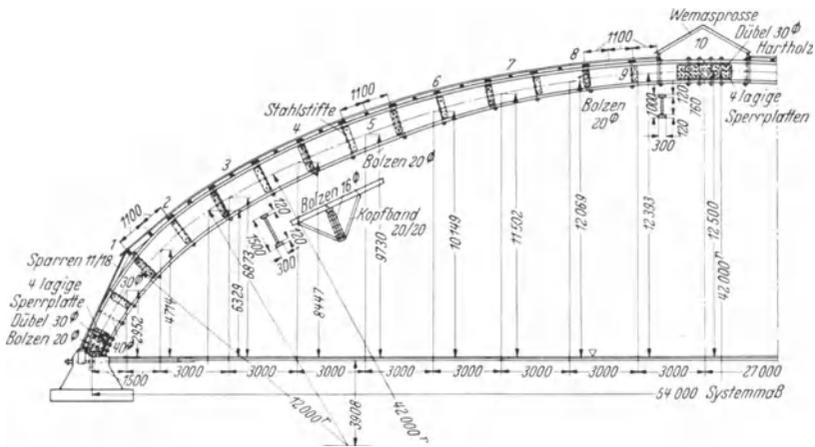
Salzlagerverspeicher Doesburg (Holland) Binderkonstruktion.
